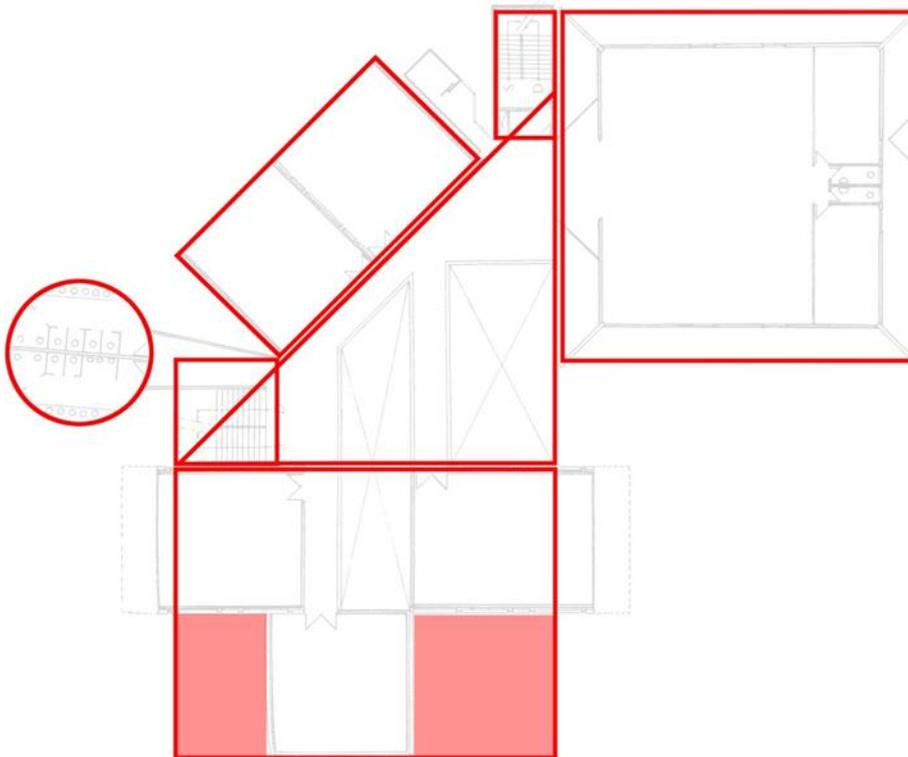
Planta esquemática para análise da relação entre planta e corte.
